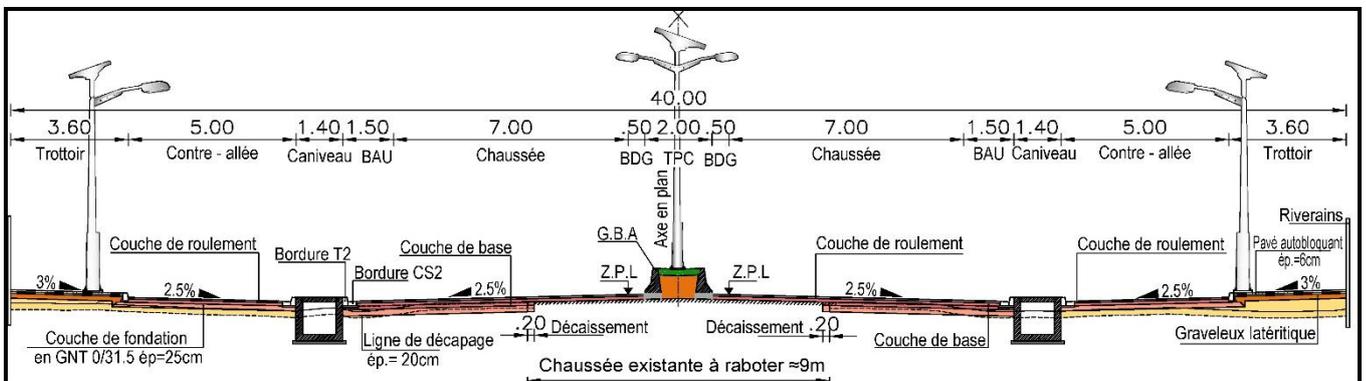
Profil en travers type de la route Ouidah-Hillacondji en zone urbaine
